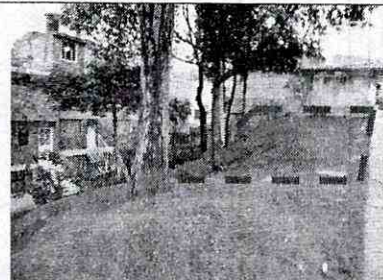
Vista actual del lote 6 donde se desarrollara el proyecto localizado en la Diagonal 37D Sur No. 1 - 23 Manzana Catastral 37.
